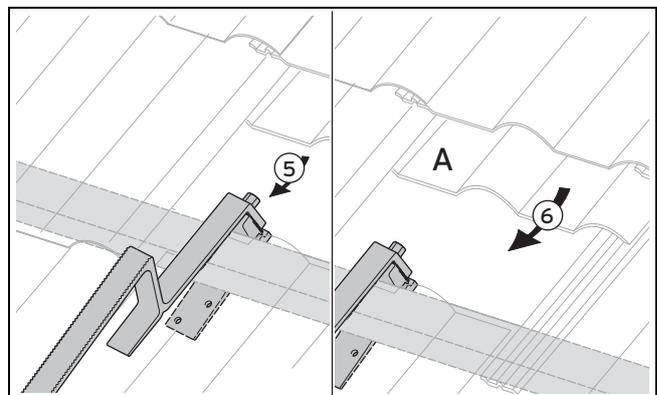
Dachanker Typ P an der Dachlatte befestigen
